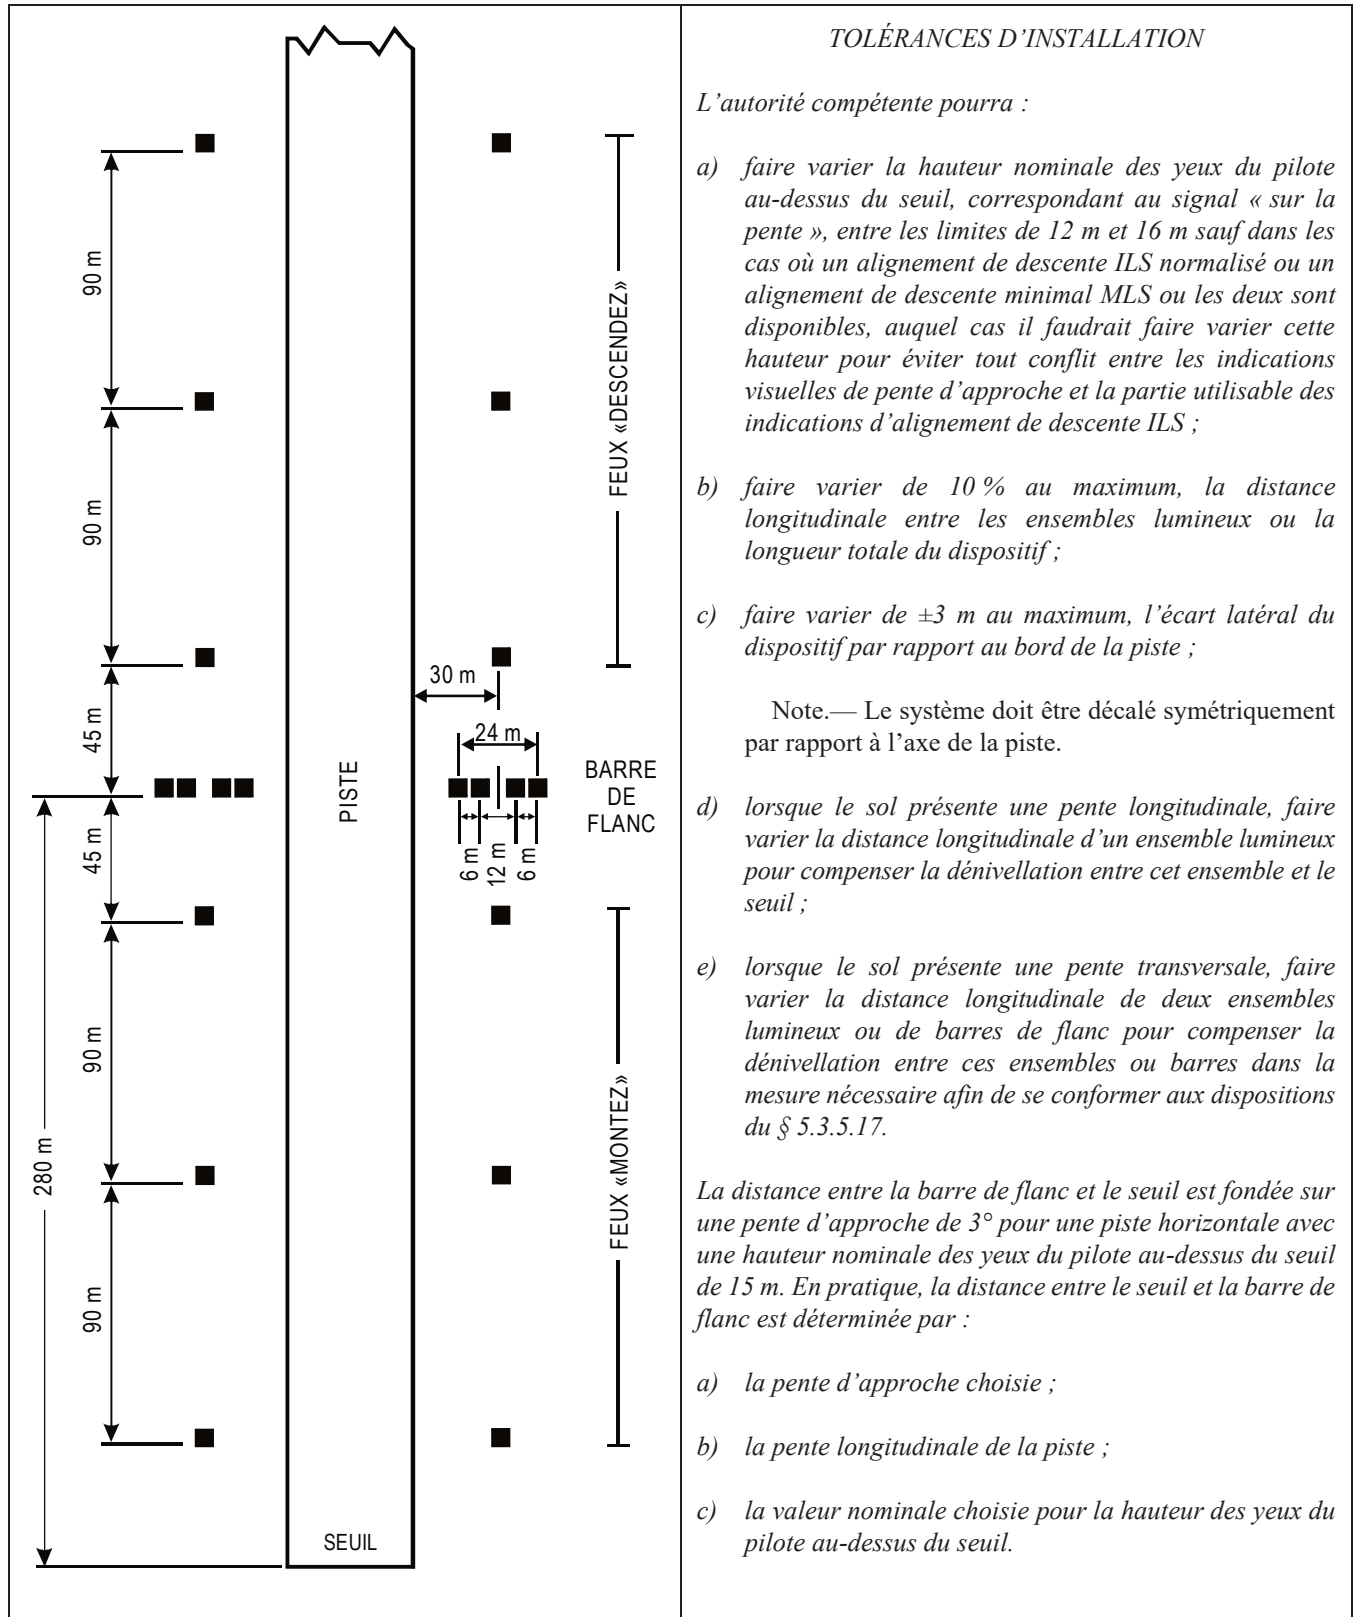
Emplacement des ensembles lumineux du T-VASIS
